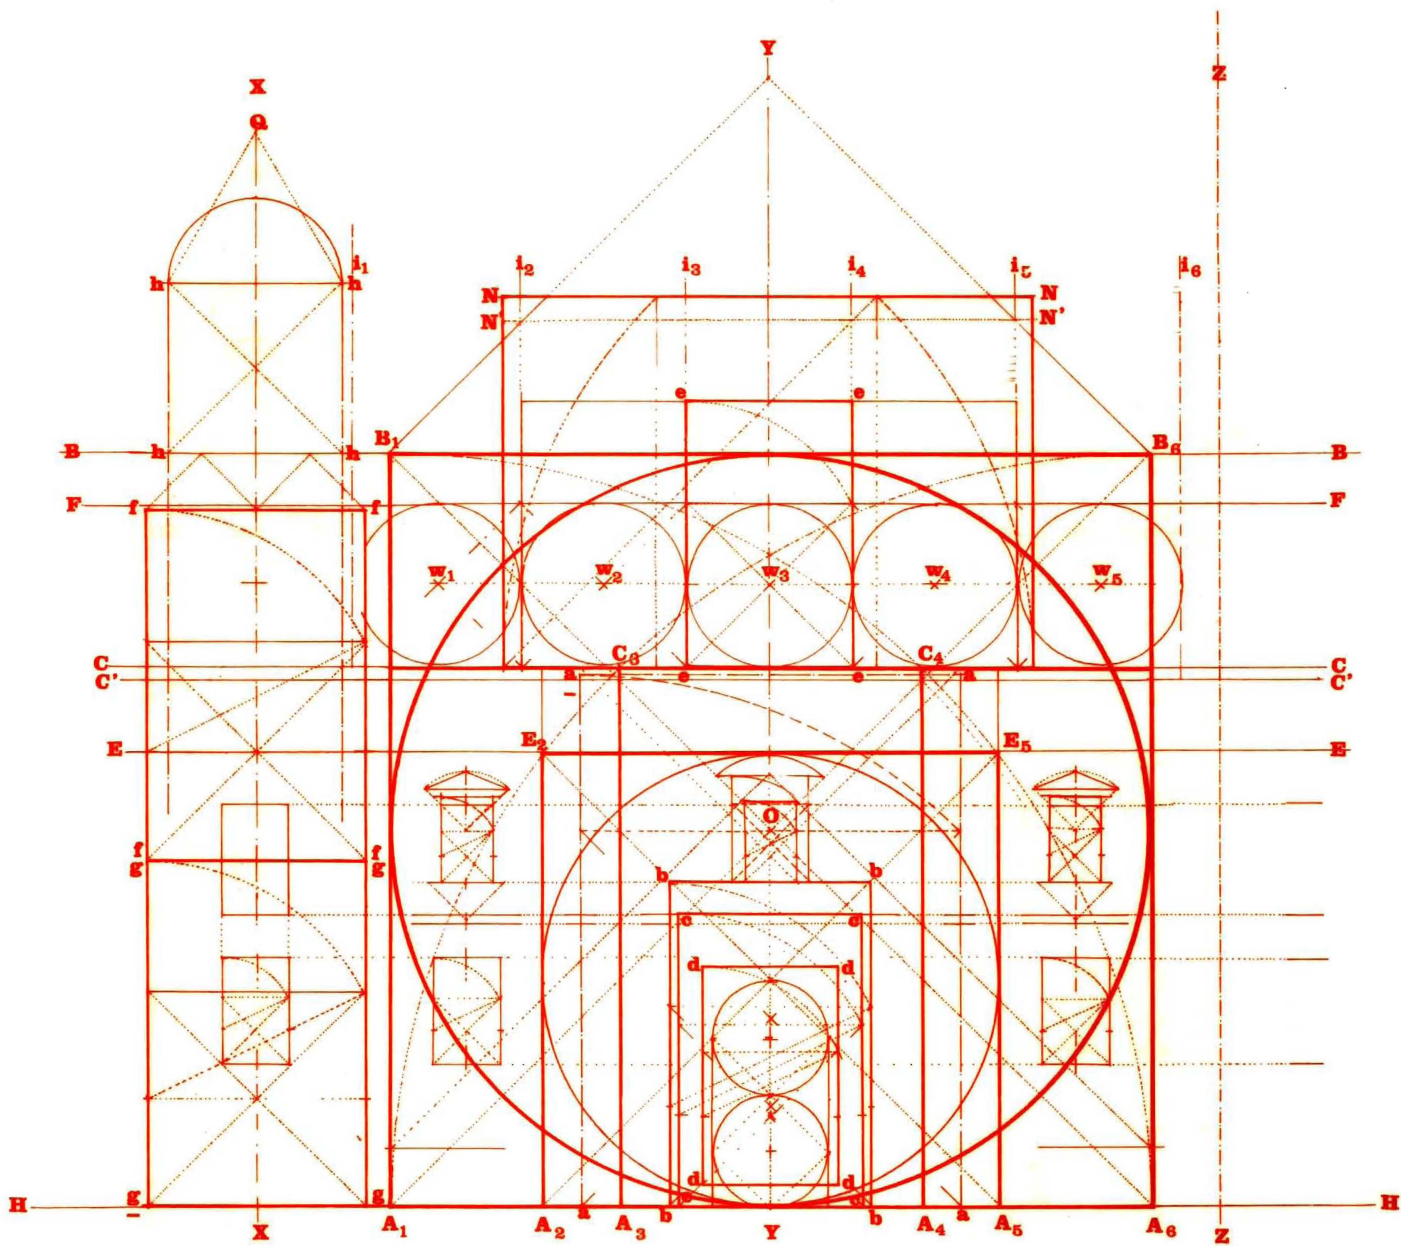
En base a las directrices armónicas fijadas en Fig. 1, Fig. 2 y Fig. 3, se introduce el orden ornamental elegido. - EL ORDEN DÓRICO-ÁTICO con estas características: módulo = 0.45 m. - ANCHO DE PILASTRA 2 m = 0.90 m. - ALTURA DE PILASTRA 19 m ó 9.5 anchos (T. edistilo y T. sistilo) ; CAPITEL DÓRICO - 1 m. = 0.45 m. - BASA ÁTICA (dos toros, 1 escocia y filetas + dado) : 1 m. = 0.45 m. - Entablamento liso, friso sin triglitos, y cornisa con denticulos. - arquivitrabe 1 m. = 0.45 m. - Friso 1 m. = 0.45 m. y Cornisa 1.5 m. - Entablamento 5 módulos. Pedestal 6 módulos. Se traza la boca en arco de medio punto f-f-f-f. y. Los BALCONES g-g-g (ORDEN DÓRICO-ÁTICO - Ref. I. ARPE - LIV CARVI).
